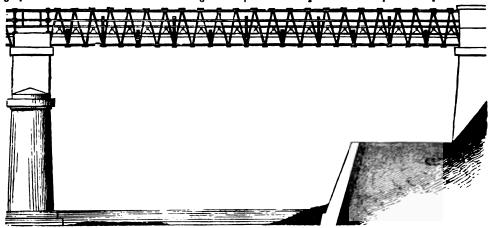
Traves d'un pont de 22 mètres d'ouverture, suivant le système Neville.
